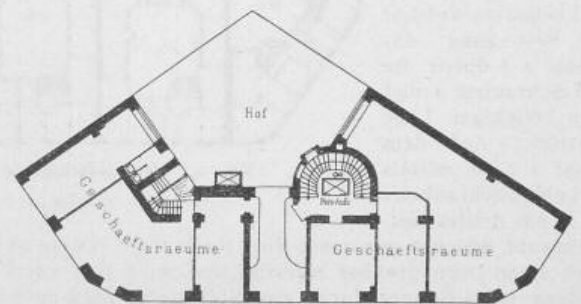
Kaufhaus Köln. Erdgeschoss 1:500.
